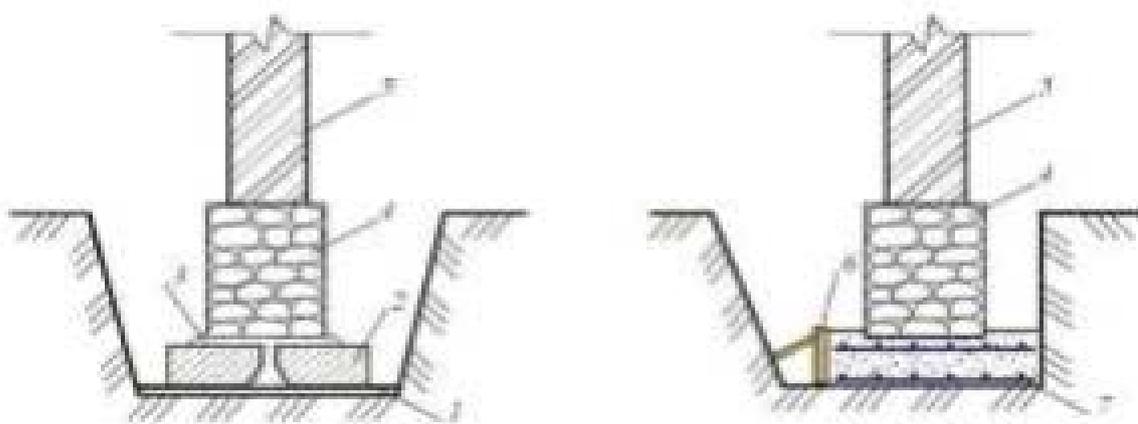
Поширення підшви фундаменту: 1- ущільнена ґрунтова підготовка; 2-залізобетонні плити; 3-цементно-піщаний розчин; 4-фундамент; 5-стіна; 6-опалубка; 7-арматурна сітка
